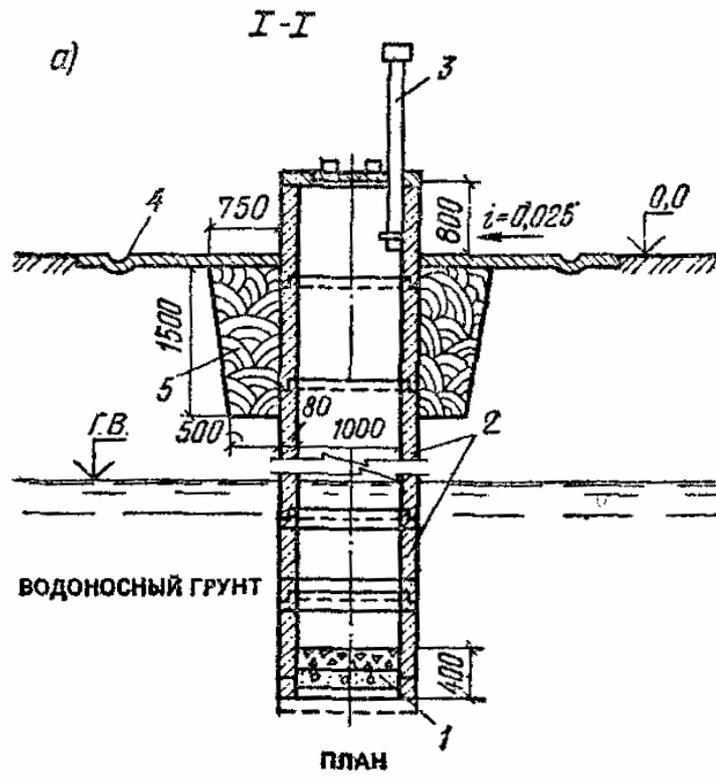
Конструкция несовершенного шахтного колодца из сборных железобетонных колец
